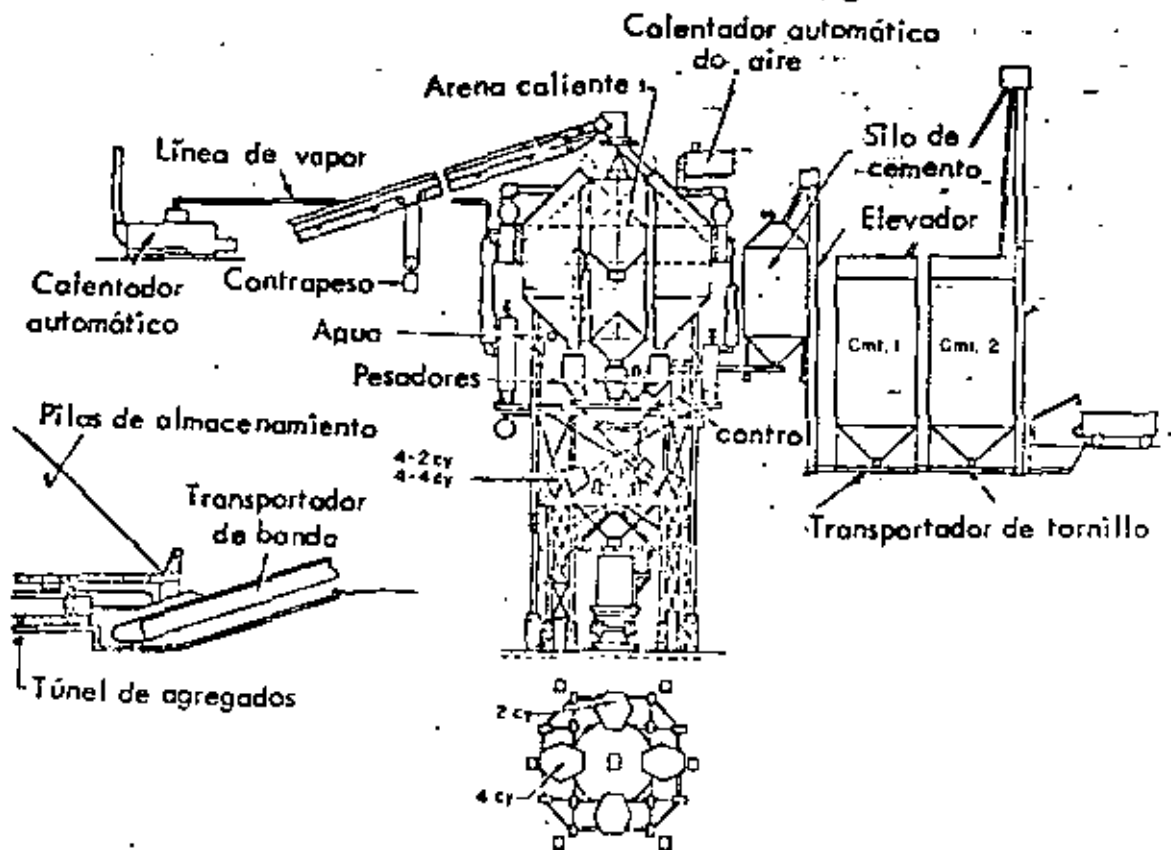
Planta central de concreto de 4 revolvedoras de tipo basculante con sistema Integral de calentamiento. El abastecimiento de agregados a las tolvas de la planta se efectúa a través de un transportador de banda que carga en las pilas de almacenamiento y descarga a un distribuidor en la planta. Dos silos de almacenamiento de cemento abastecen al silo de la planta a través de un transportador de tornillo y un elevador. El funcionamiento es totalmente automático.
